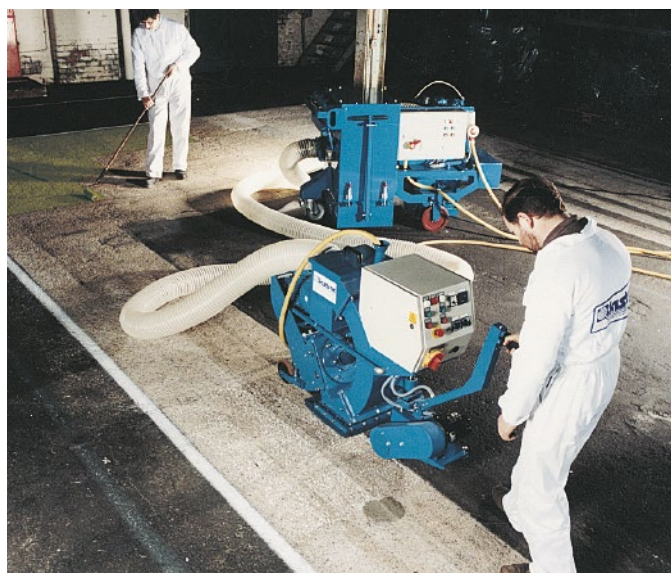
Grenaillage du plancher en béton destiné à la pose d'une chape adhérente
